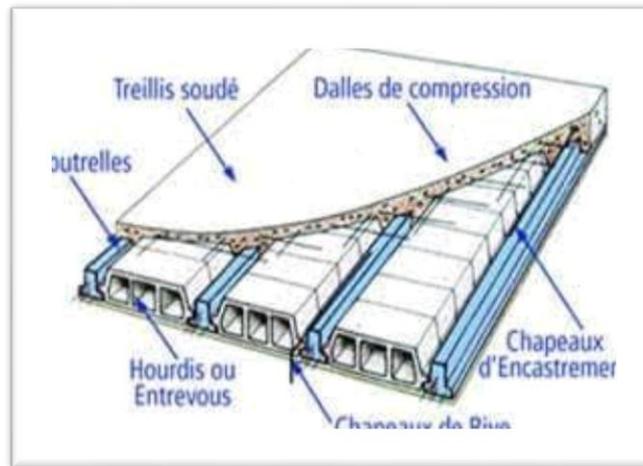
Le rôle de l'hourdis sur le plancher (dalle de compression) [1]
